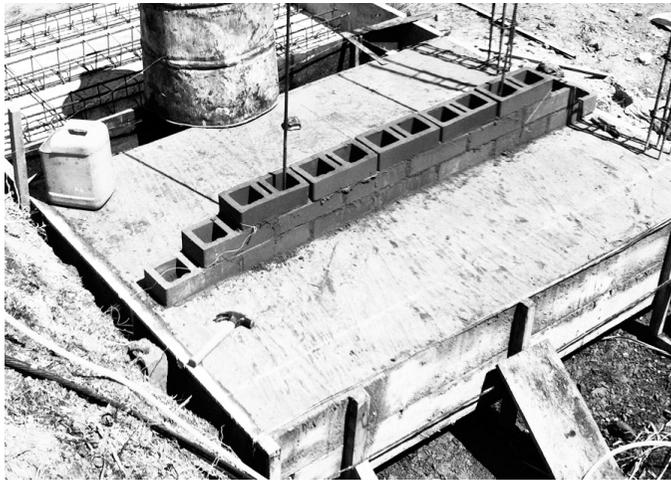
Primeras hiladas de muro de prueba de ladrillo industrial construido como mampostería estructural.
